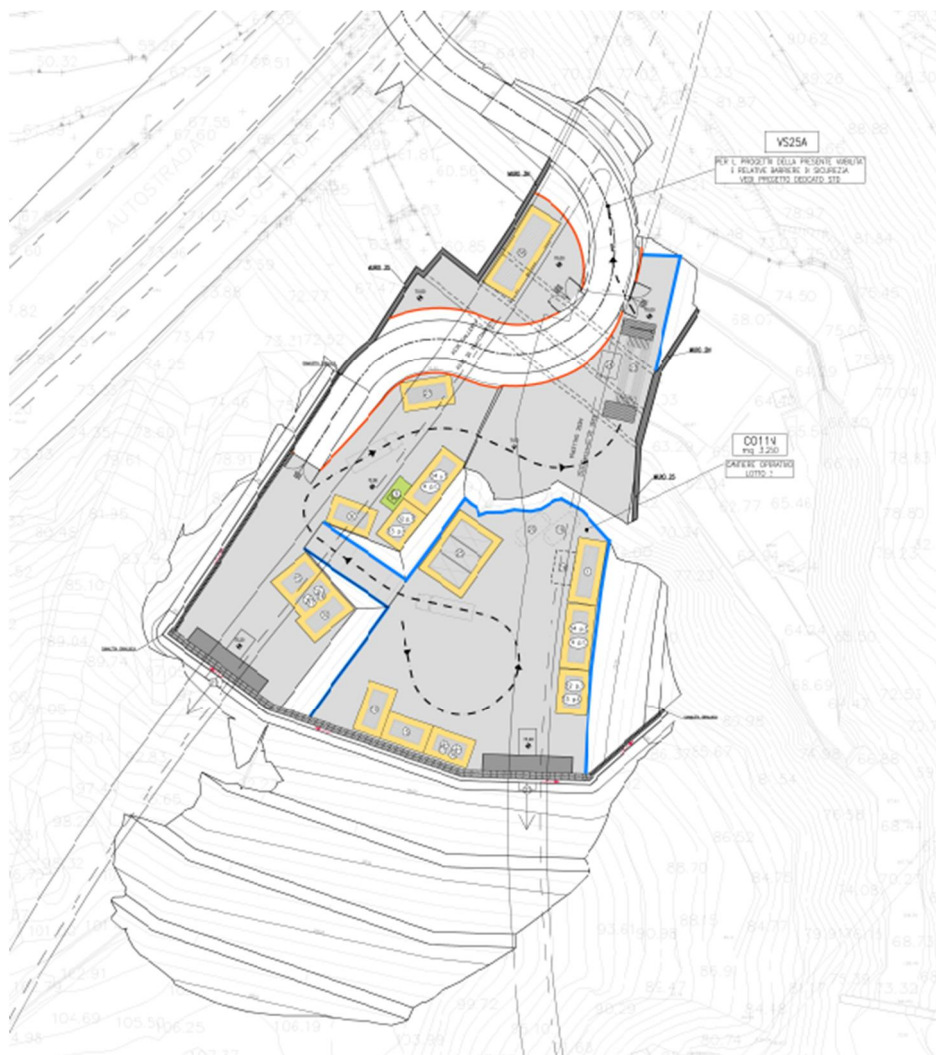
Layout CO11N - apprestamenti di cantiere
